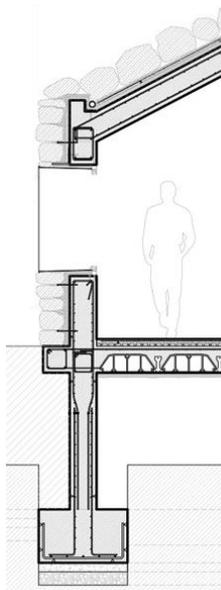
Detalle forjado sanitario apoyado sobre la misma estructura del edificio.
